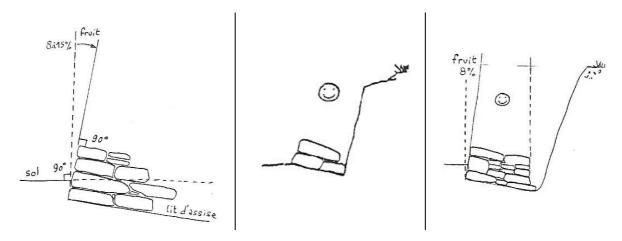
Inclinaison des lits perpendiculaire au fruit (à gauche); Fondation sur support rocheux (au centre); Fondation sur sol dur ou meuble (à droite)
